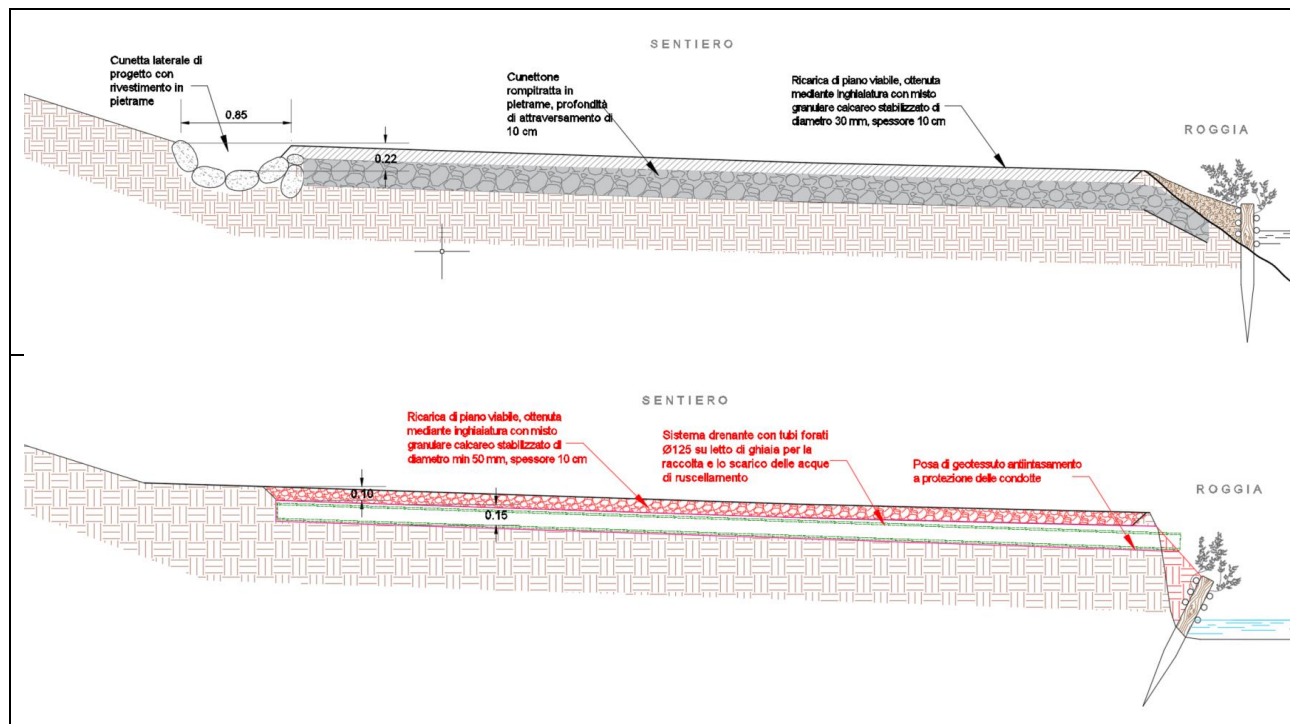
sistema di drenaggio del sentiero: a) progetto approvato; b) variante proposta
